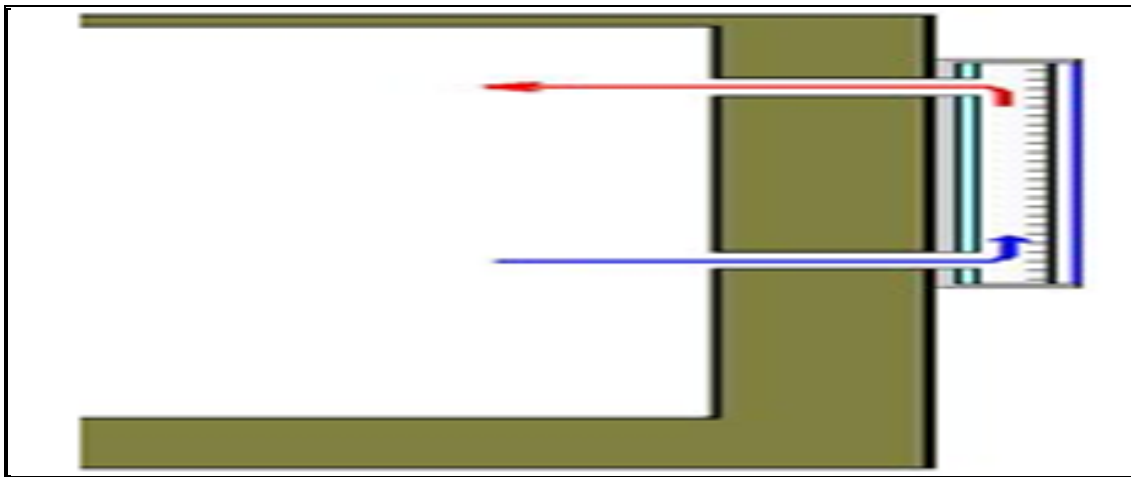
Muro transversal con un colector adosado a una fachada (Montejano, 2008)
